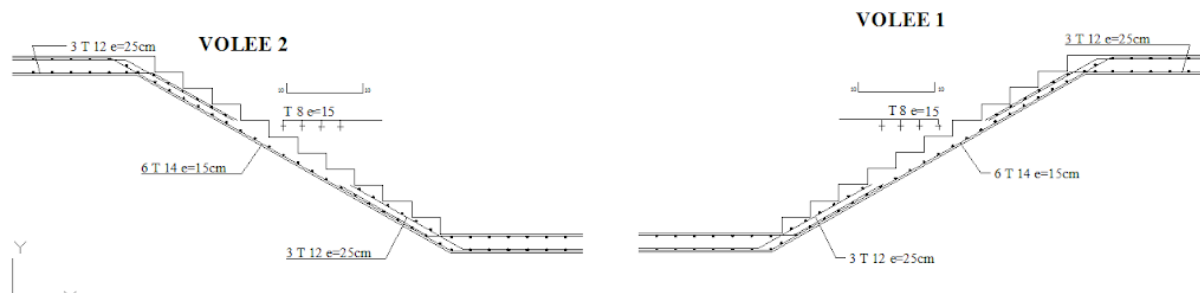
schéma de ferrailage d'escalier (étage courant).
